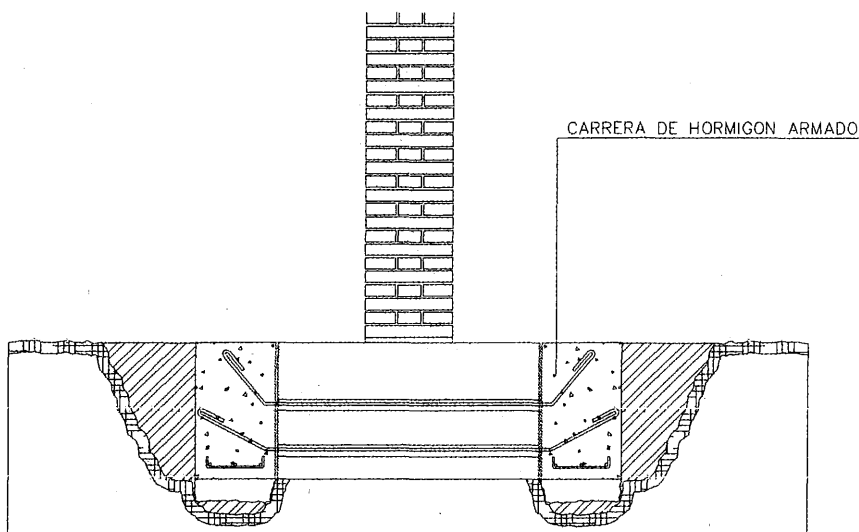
Recalce superficial de zanja corrida aumentando su superficie de apoyo mediante carreras laterales unidas por armaduras pasantes.
